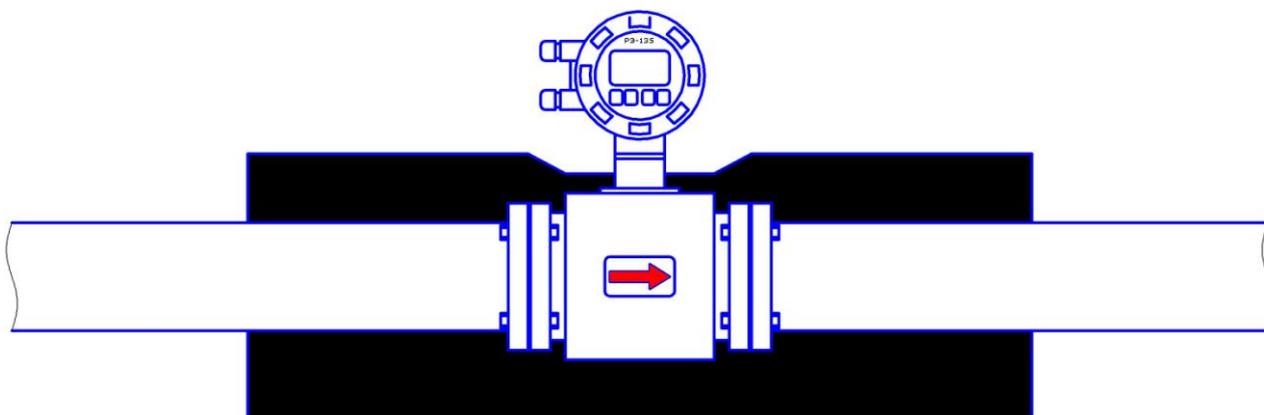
Рекомендации по теплоизоляции трубопровода в месте установки расходомера
